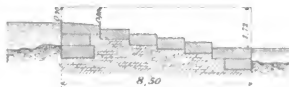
Steinernes Stufenwehr. M. 1:200.
